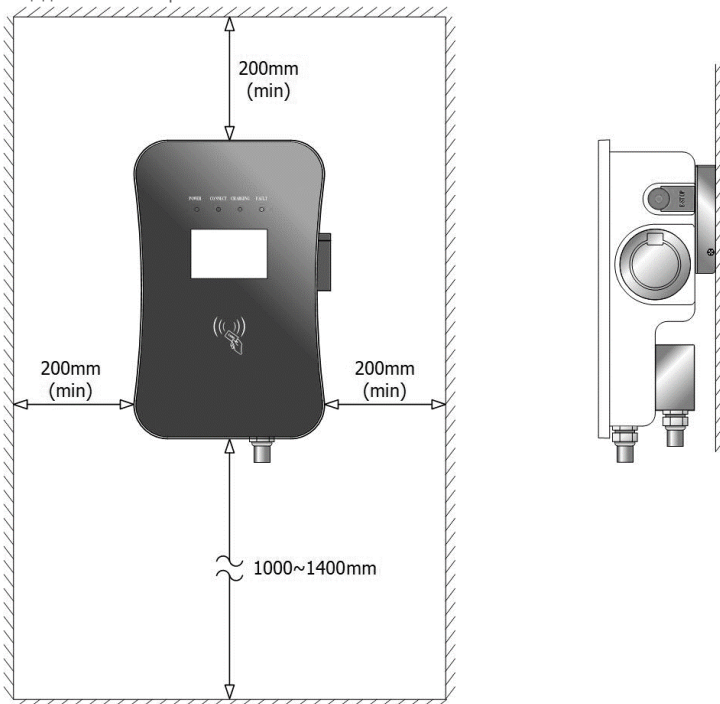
Минимальная необходимая площадь для настенного монтажа
